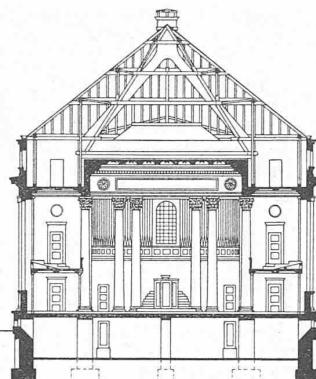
bis 20. Grundrisse und Querschnitte. — 1:500.
